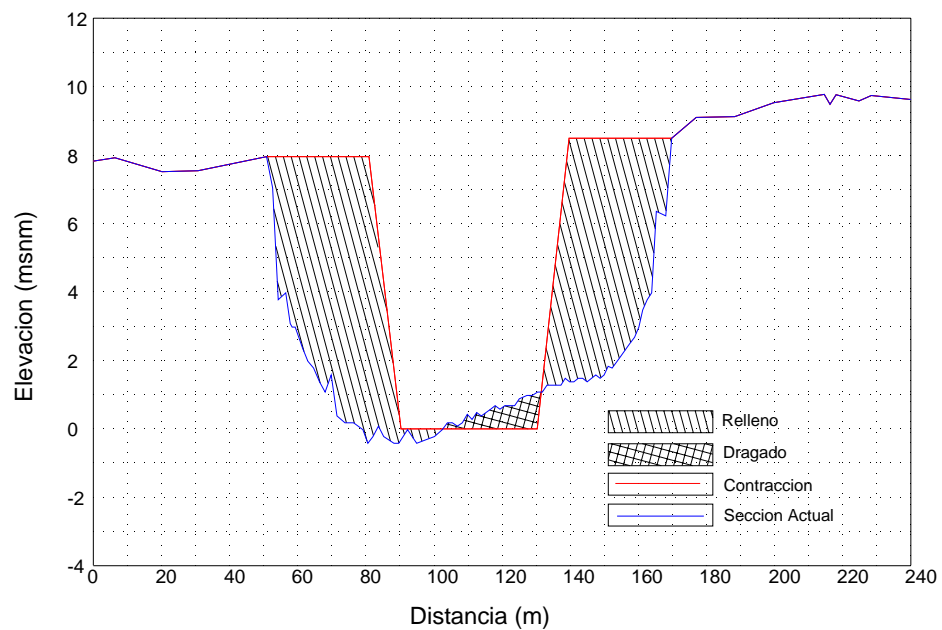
Sección transversal km 2 - Contracción No. 1
